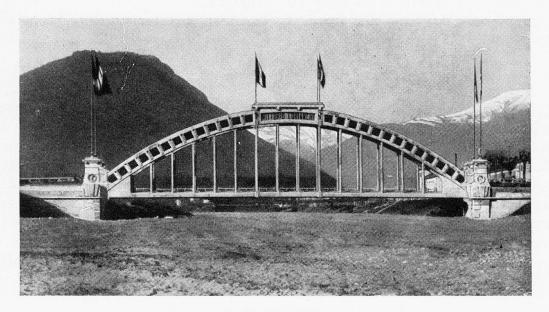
Pont ferroviaire à Intra = Eisenbahnbrücke bei Intra = Railway bridge at Intra.
